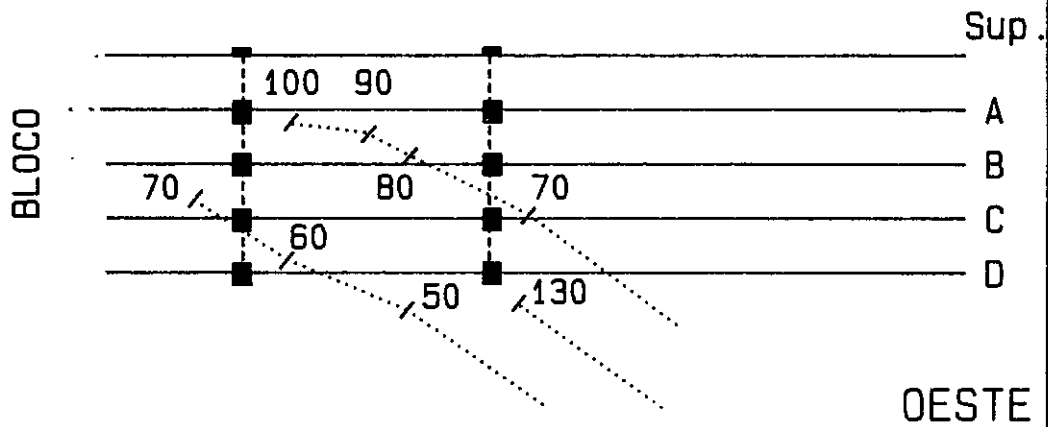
a Fissuras na seção 3 da viga VB1,
